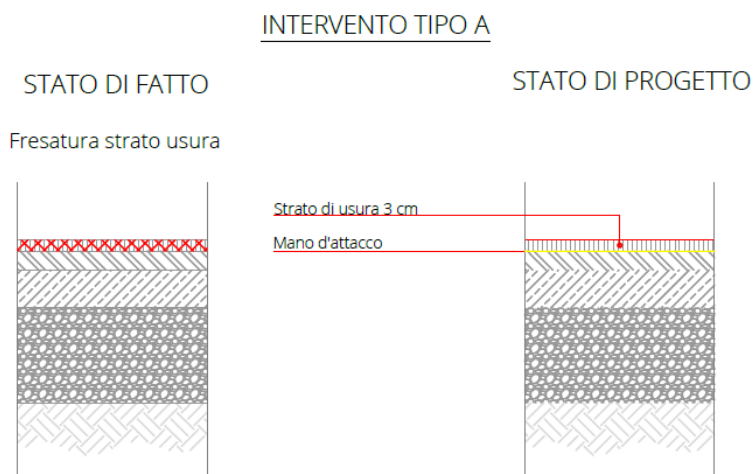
Rifacimento pavimentazione stradale – Tipo A
